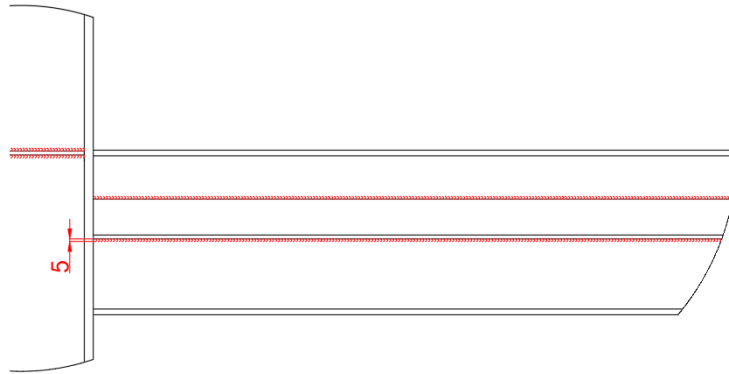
Unión perfil de apoyo forjado LPN-80.
